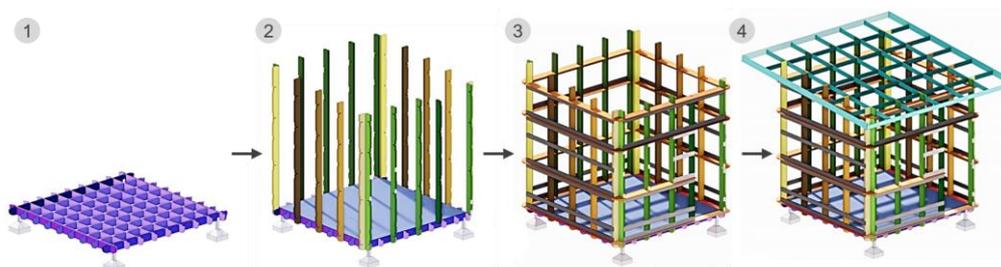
1) Fundação + estrutura do piso; 2) Piso + pilares; 3) Piso + pilares + travamentos horizontais; 4) Estrutura das paredes + estrutura da cobertura. Fonte: Equipe de apoio, 2023.
